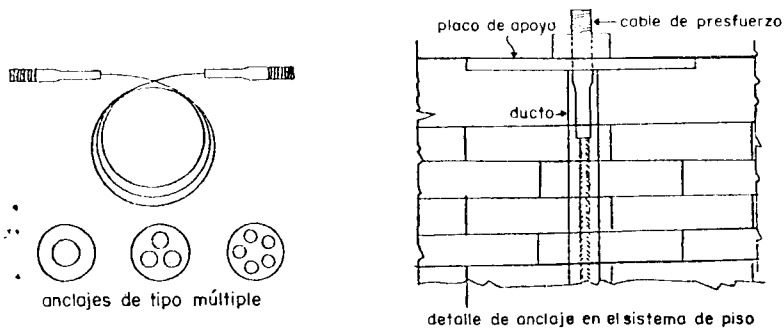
Aplicación del sistema de postensado RAMSA en mampostería.
